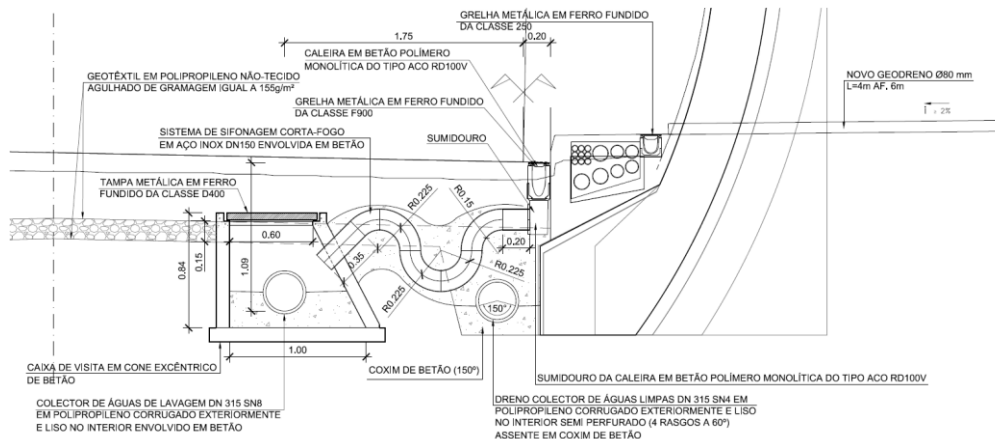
Ligação sifonada entre a caleira do pavimento e o colector [7].
